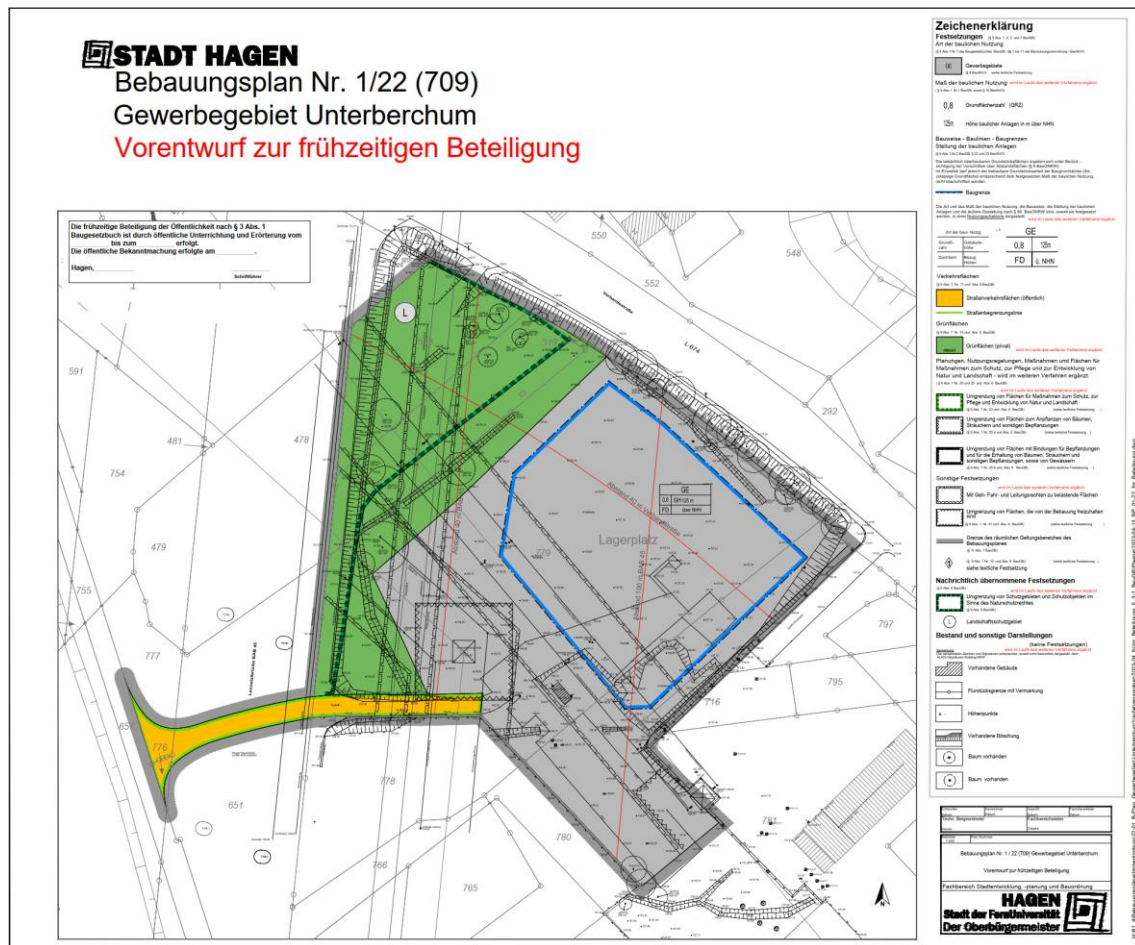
Bebauungsplan Nr. 1/22 (709) (Vorentwurf Stand: 25.03.2024)
